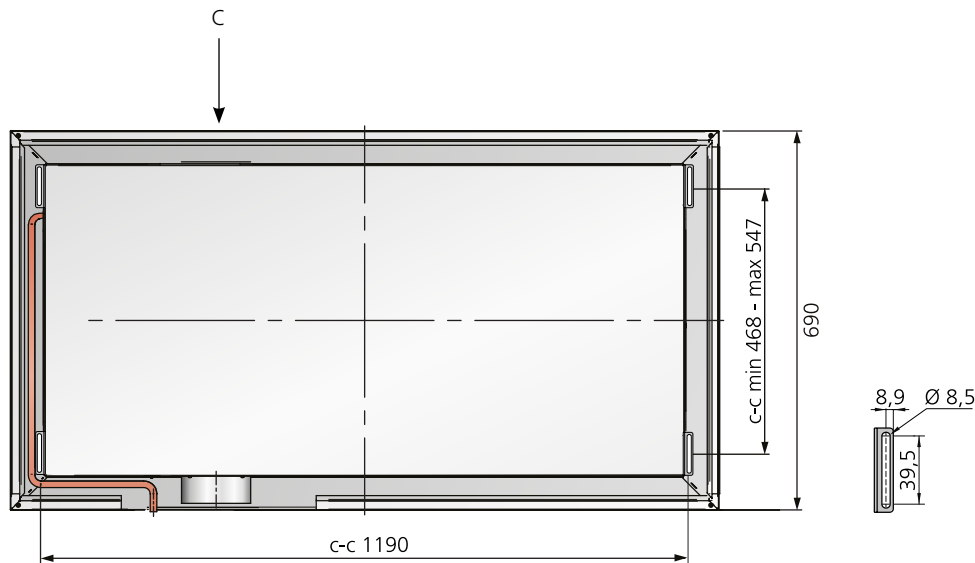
Parasol EX 1290, Ansicht von oben mit Anschlussbefestigung
